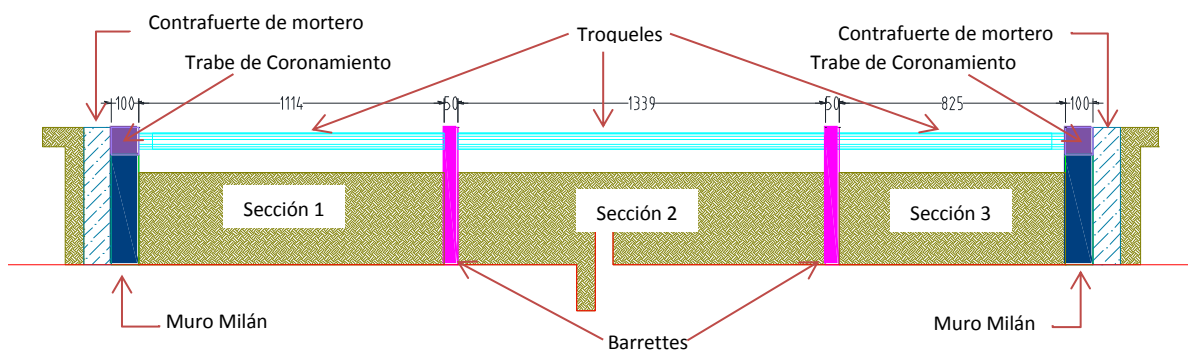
Sección de la excavación y colocación de troqueles.
